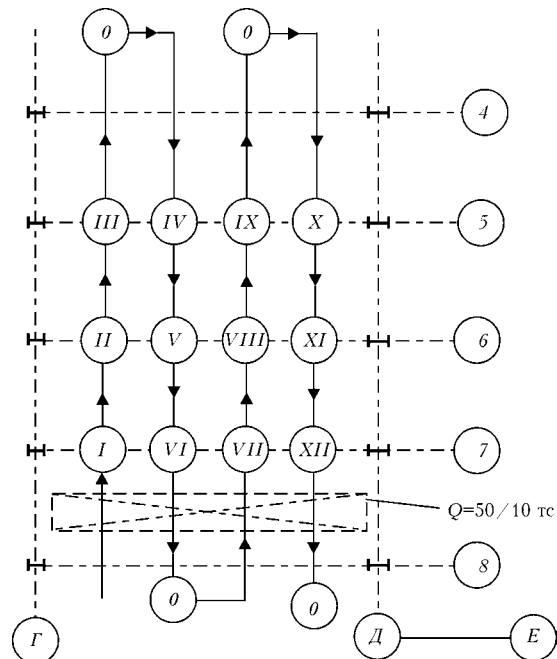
Схема установок испытательной нагрузки на объекте испытаний
